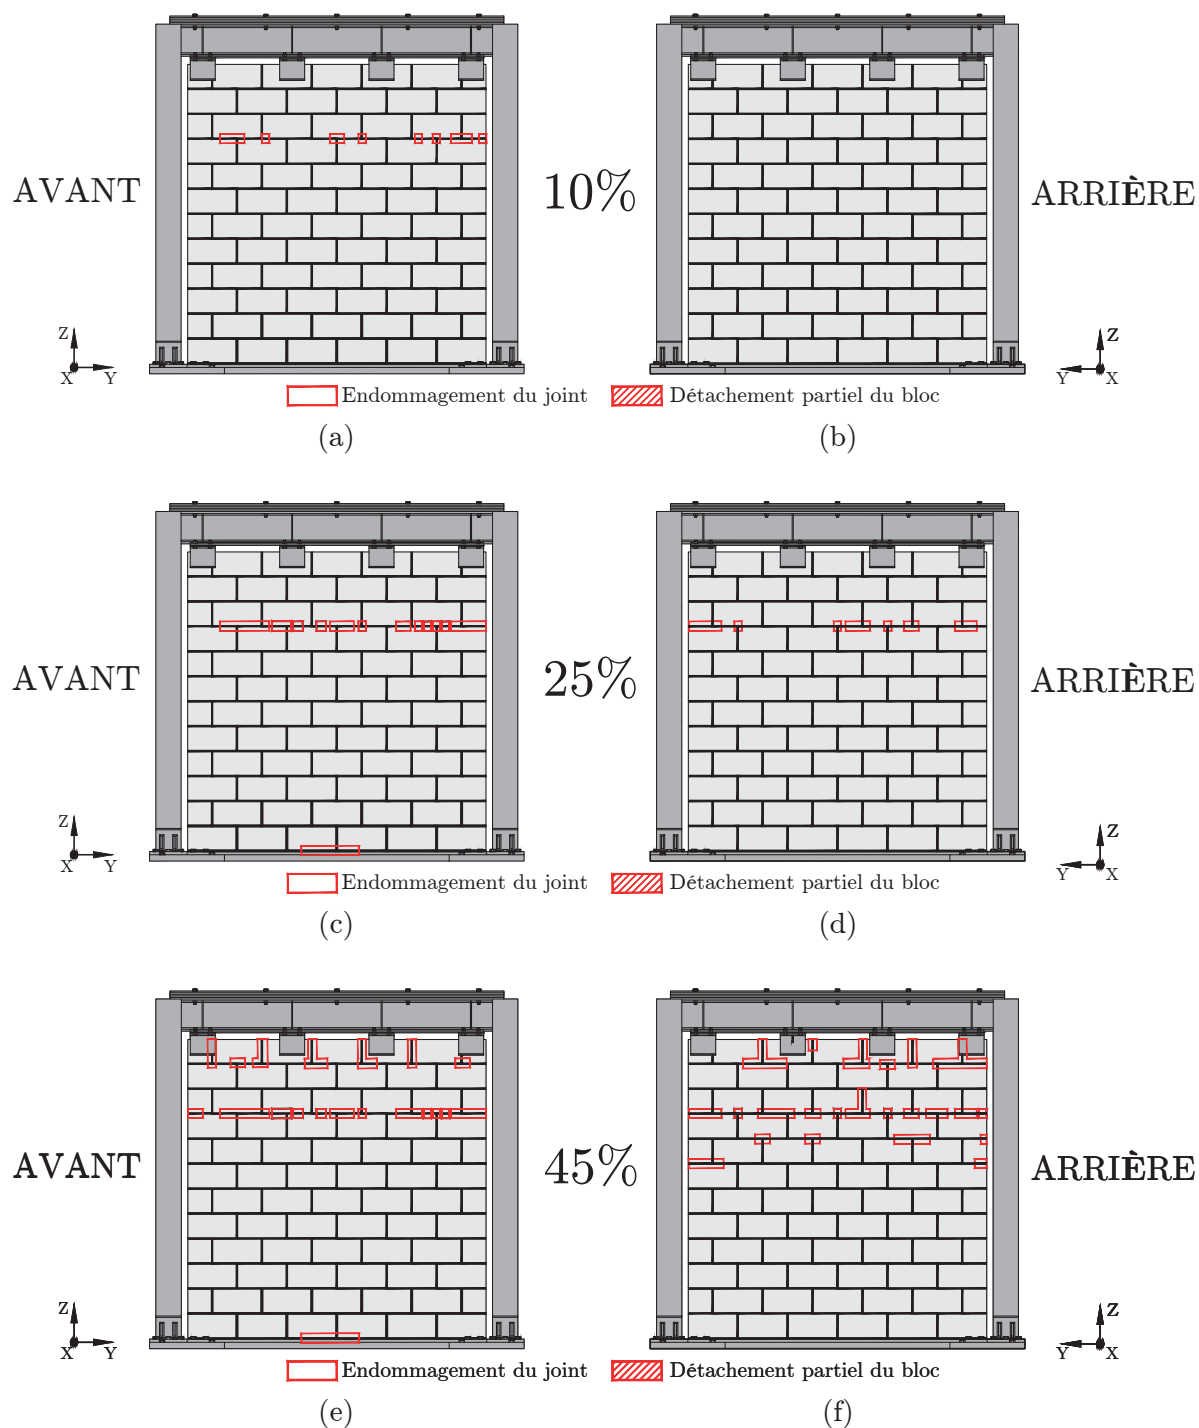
Représentation visuelle de l'endommagement du mur 1 après l'essai (a) MAL4-0.10 - façade avant (b) MAL4-0.10 - façade arrière (c) MAL9-0.25 - façade avant (d) MAL9-0.25 - façade arrière (e) MAL13-0.45 - façade avant (f) MAL13-0.45 - façade arrière
